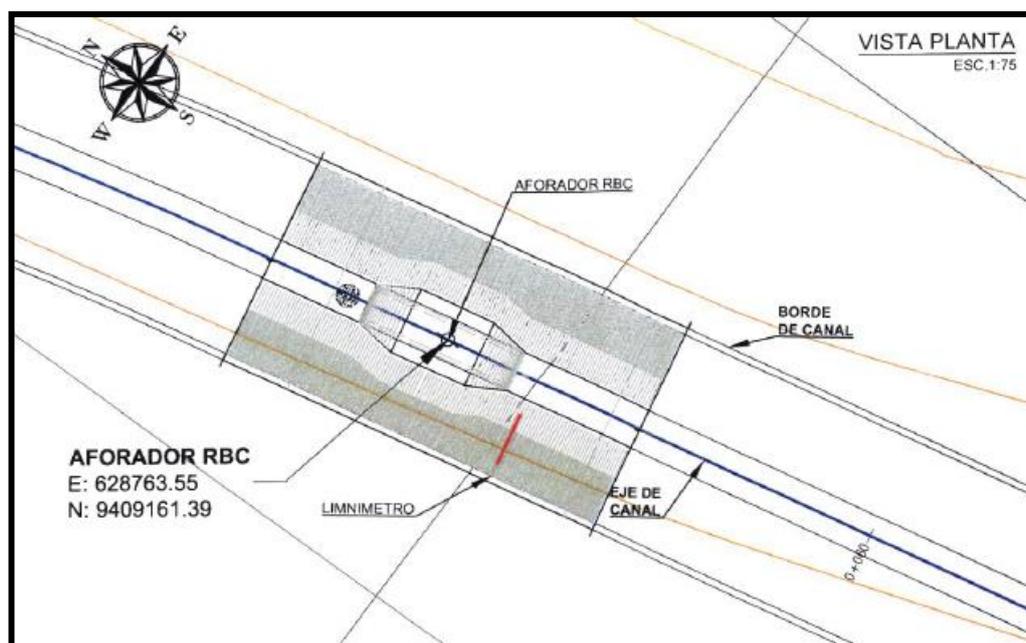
Sección de Planta de AFORADOR RBC con detalle de juntas.
